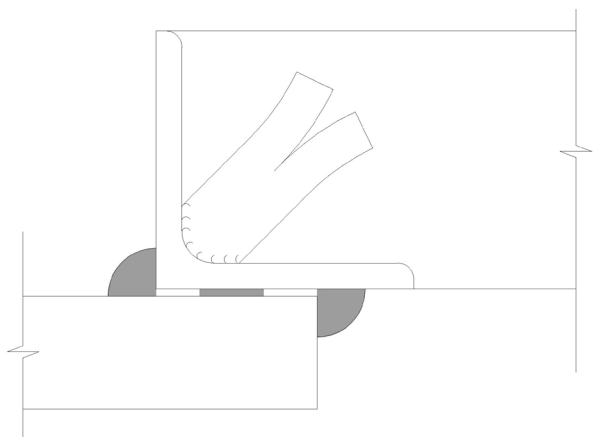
Detalle de anclaje de las prelosas en el perfil central
